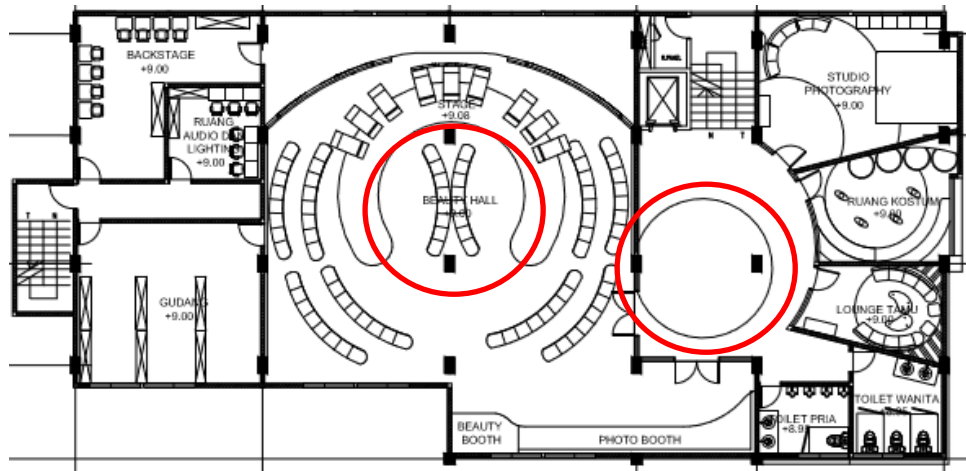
3 Layout Furniture Lantai Satu dan Dua
